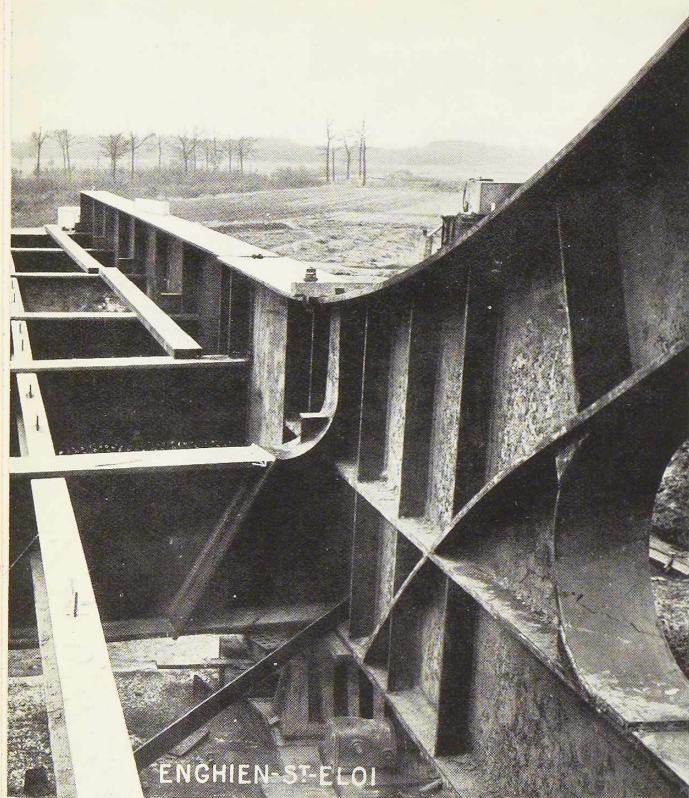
Détail de l'assemblage par soudure d'une pièce de pont au longeron. Le joint se fait par soudure sur une plaque inclinée soudée en atelier sur une amorce faisant corps avec le longeron.
